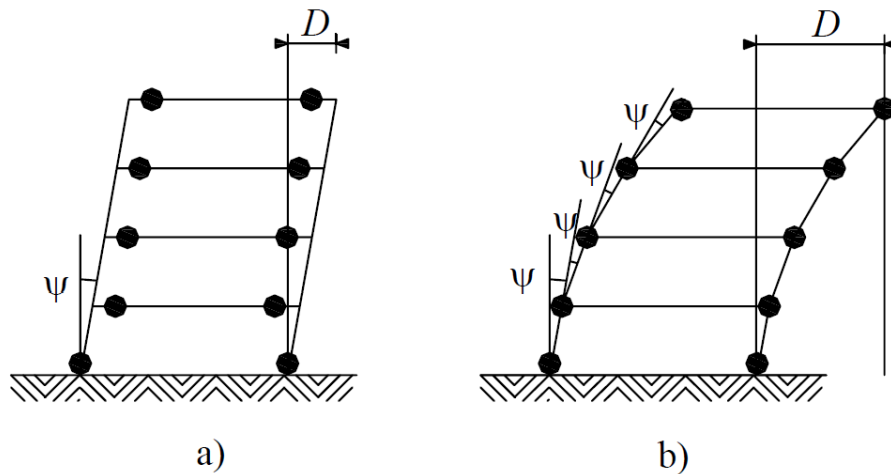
a) L'objectif de projet "poutres faibles – poteaux forts"
